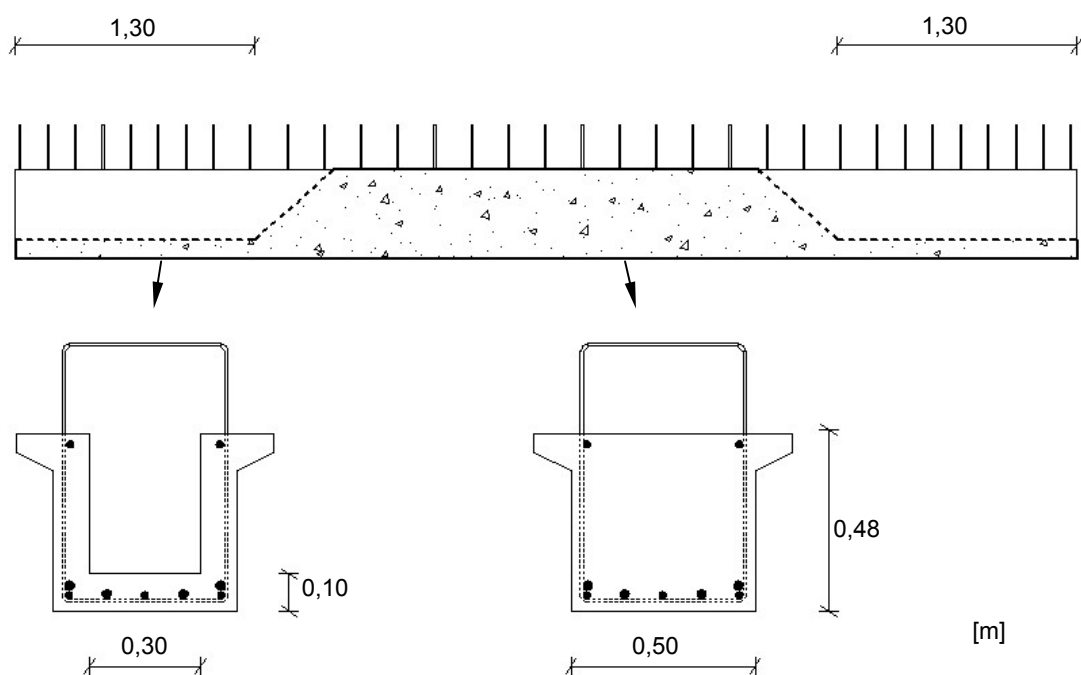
Secção tipo da viga adoptada e corte longitudinal de um vão tipo durante a fase construtiva
